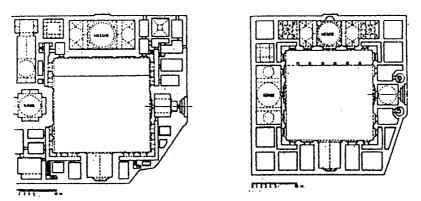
المدرسة المستنصرية ببغداد : مسقط أفقي للطابق الأرضي .
